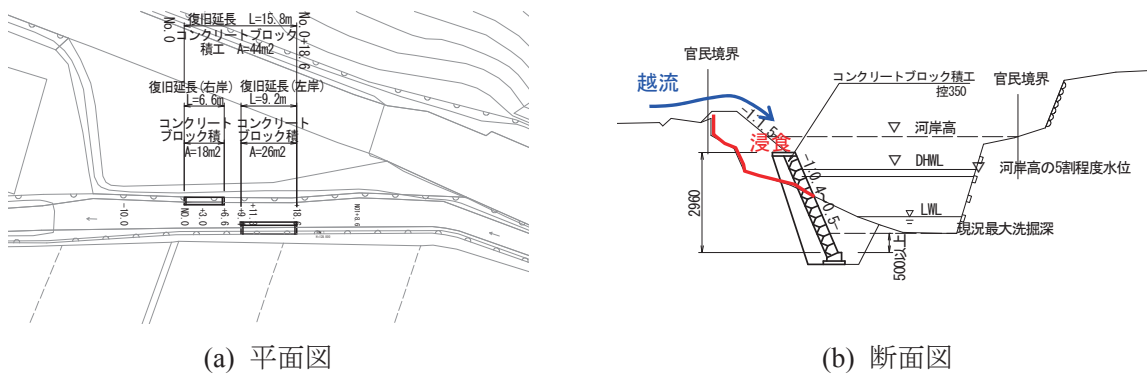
護岸の平面図と横断面図 (No.6 左岸)
